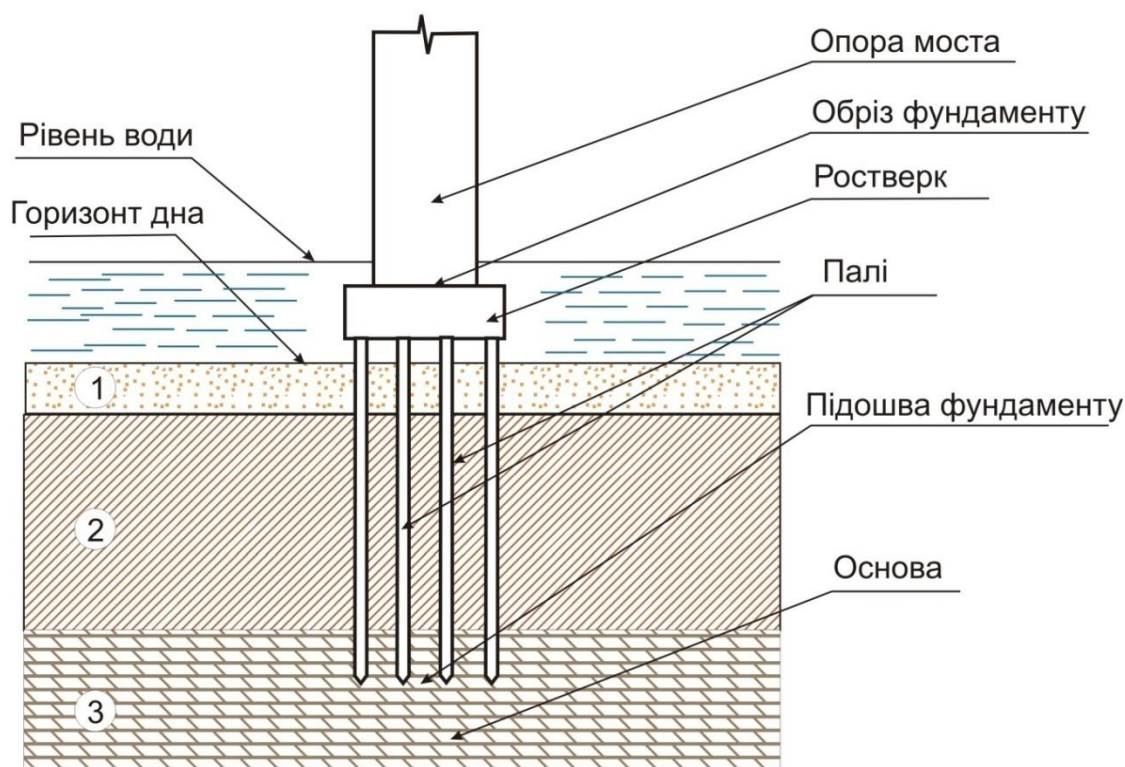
Конструкція пальового фундаменту з високим ростверком
